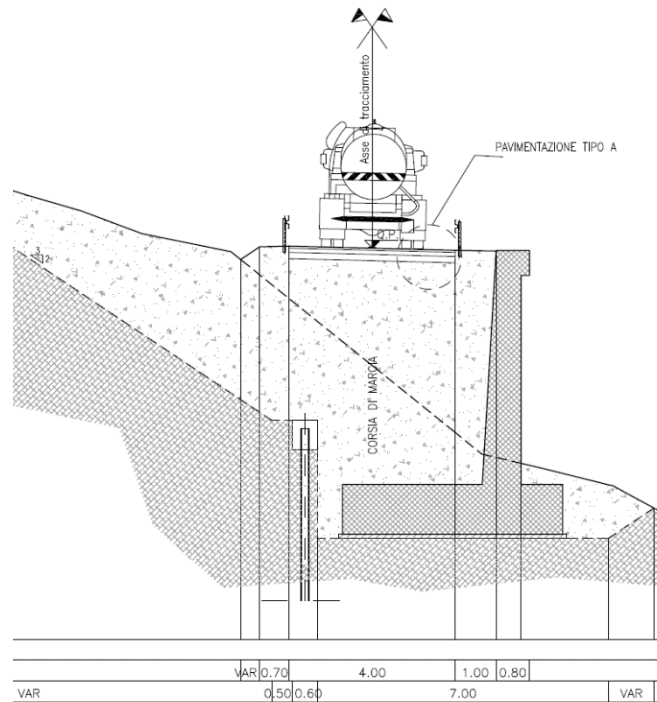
Sezione tipo strada di cantiere/security (muro di contenimento)
